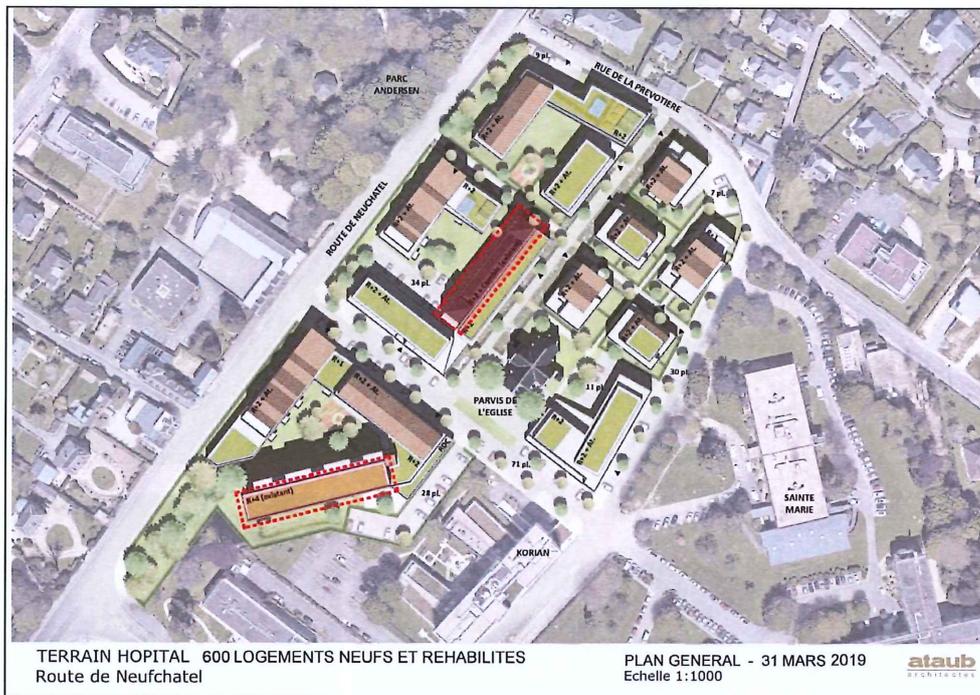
Plan masse du capacitaire au stade du concours (Kaufman & Broad)
